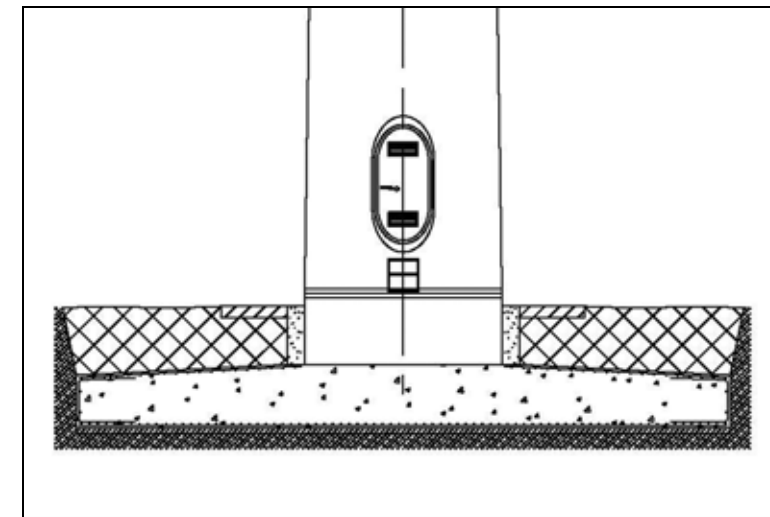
Schéma-type d'une fondation (source : GAMESA, 2014)
